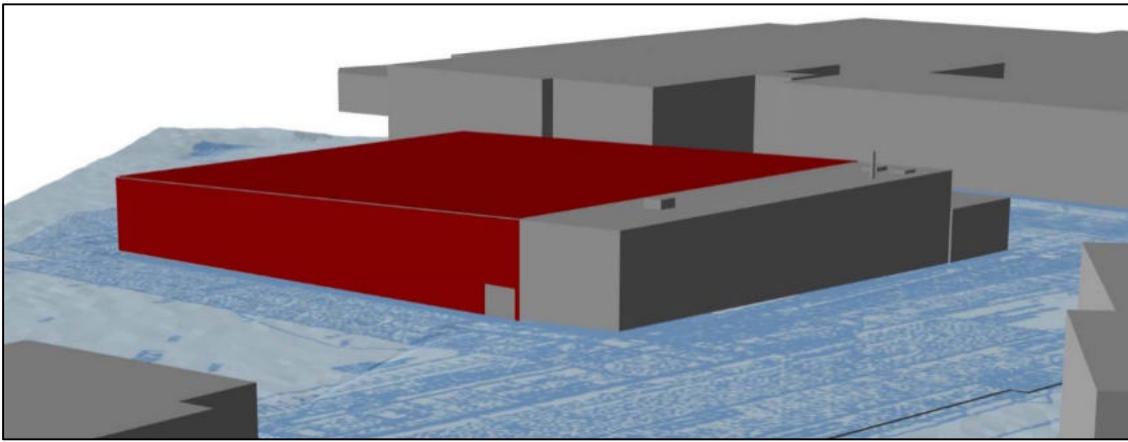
3D-Darstellung der geplanten Zweifachsporthalle, Blick nach Nordosten
